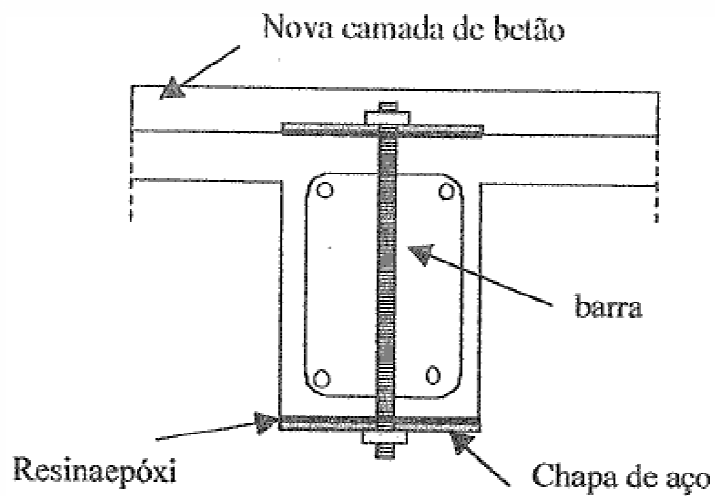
Reforço de vigas com chapas metálicas interligadas por barras (Carreira, 2000).
